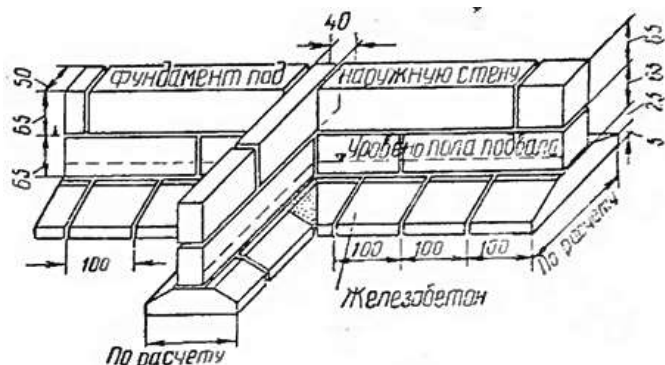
Сборный железобетонный фундамент (размеры в сантиметрах)
